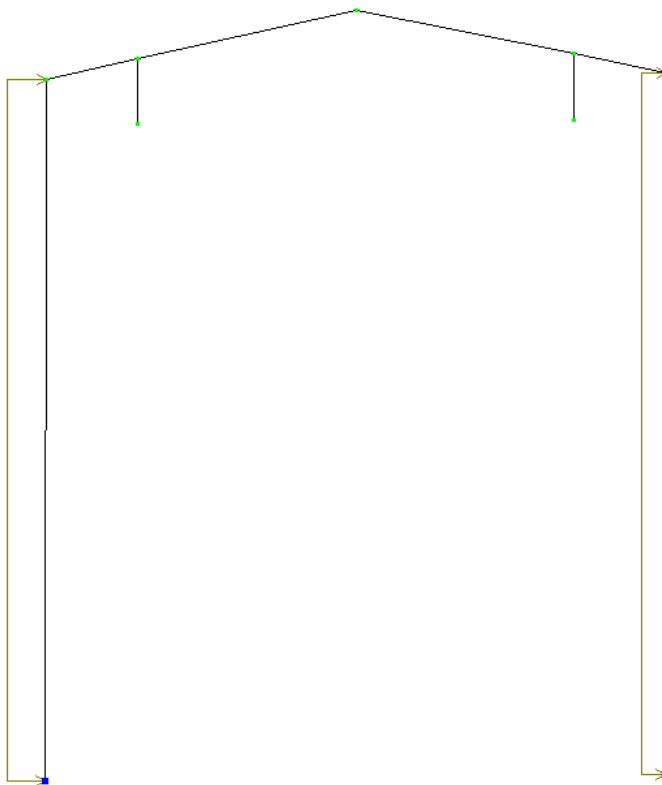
Схема приложения первого варианта ветровой нагрузки (загрузка б)
